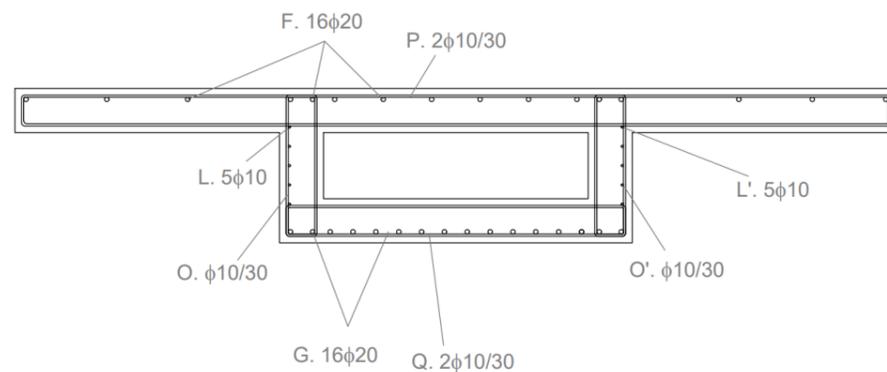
Sección transversal en centro luz ( $x=39$ ) de la armadura pasiva.
